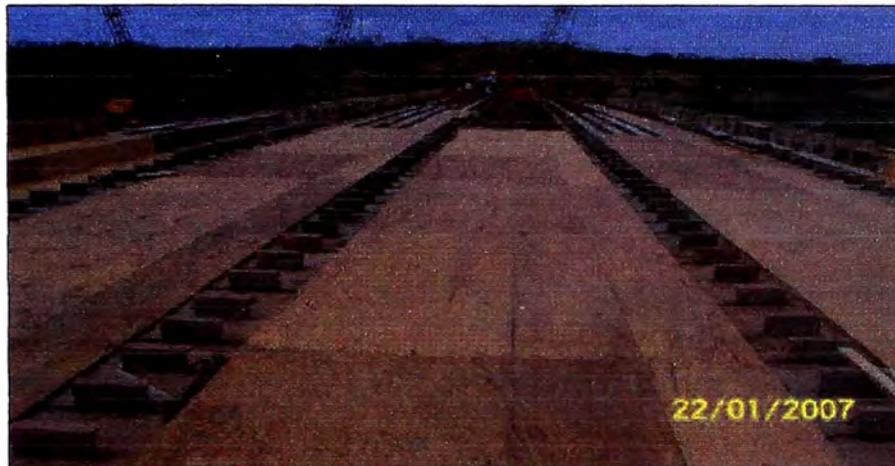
Encofrado de Pilares centrales del Puente Franco.
